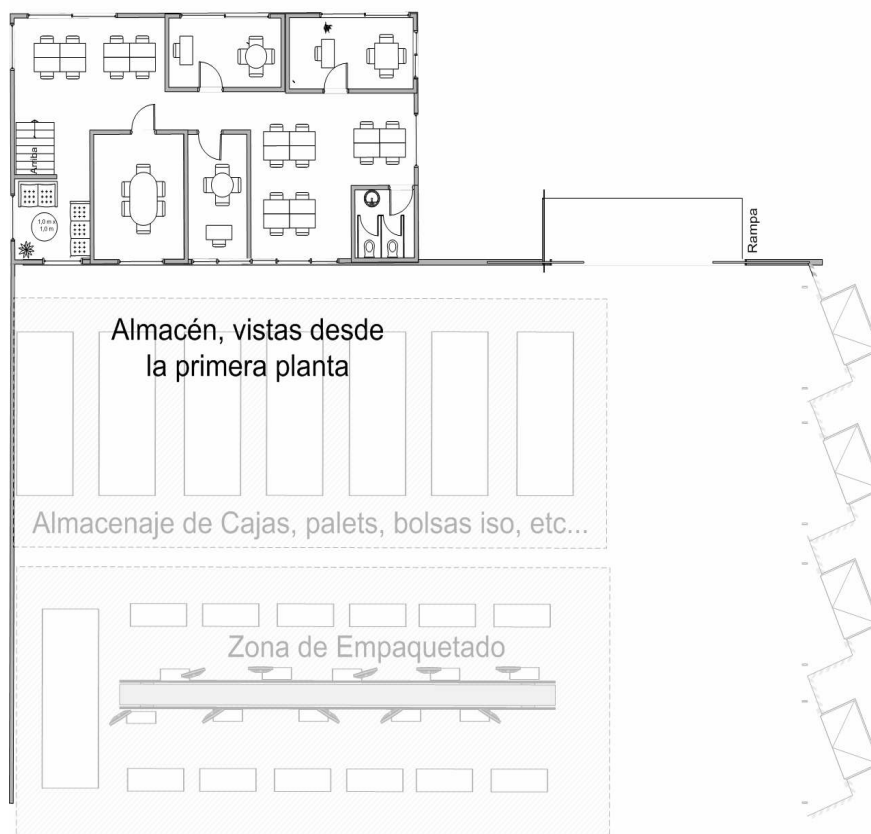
Oficinas tipo en primera planta sobre la planta calle del almacén destino.
